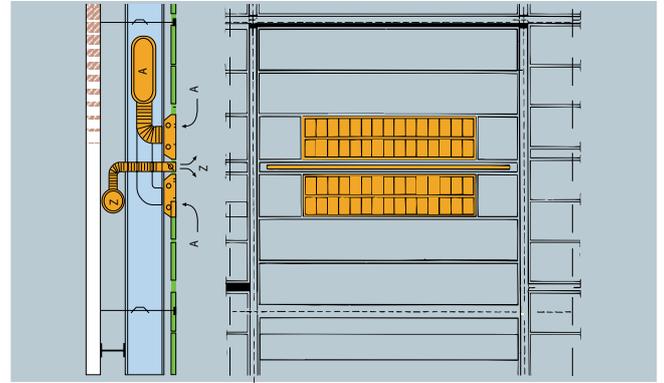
Schnitt u. Unteransicht der Decke mit Zu- u. Abluftführung
